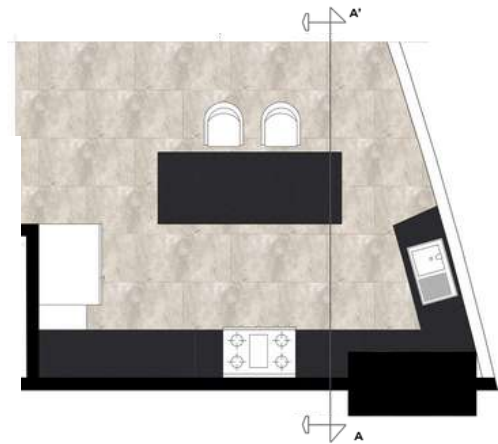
Planta de cocina con texturas, señalamiento de corte. Fuente: Autoría propia.
